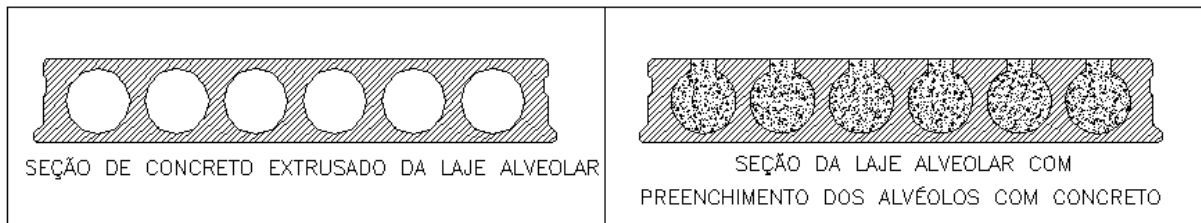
SEÇÃO TRANSVERSAL DA LAJE ALVEOLAR: SEÇÃO DE CONCRETO EXTRUSADO X SEÇÃO COM PREENCHIMENTO DE ALVÉOLOS.
